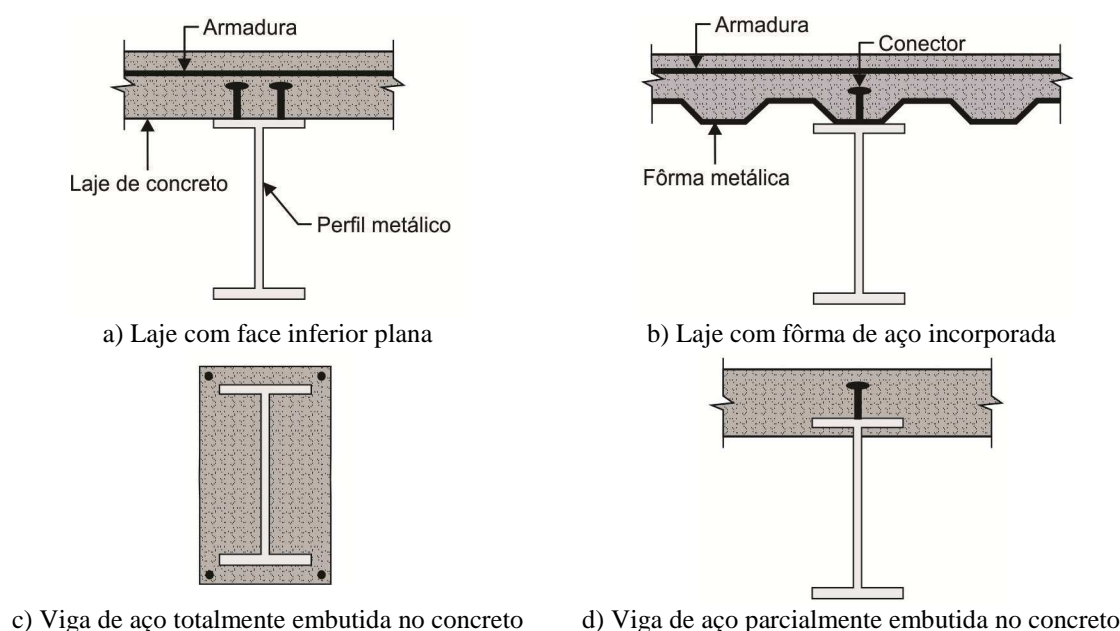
Tipos mais usuais de viga mista aço-concreto (adaptado de Malite, 1990).
